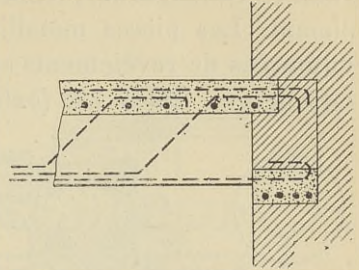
Semelle sous l'extrémité d'une poutre.
